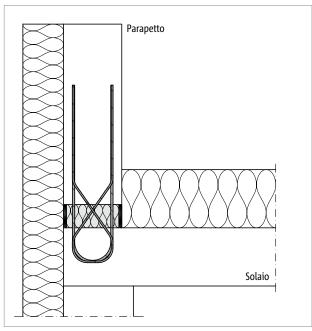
Schöck Isokorb® T tipo AP disposizione verticale: raccordo di un parapetto sovrapposto
